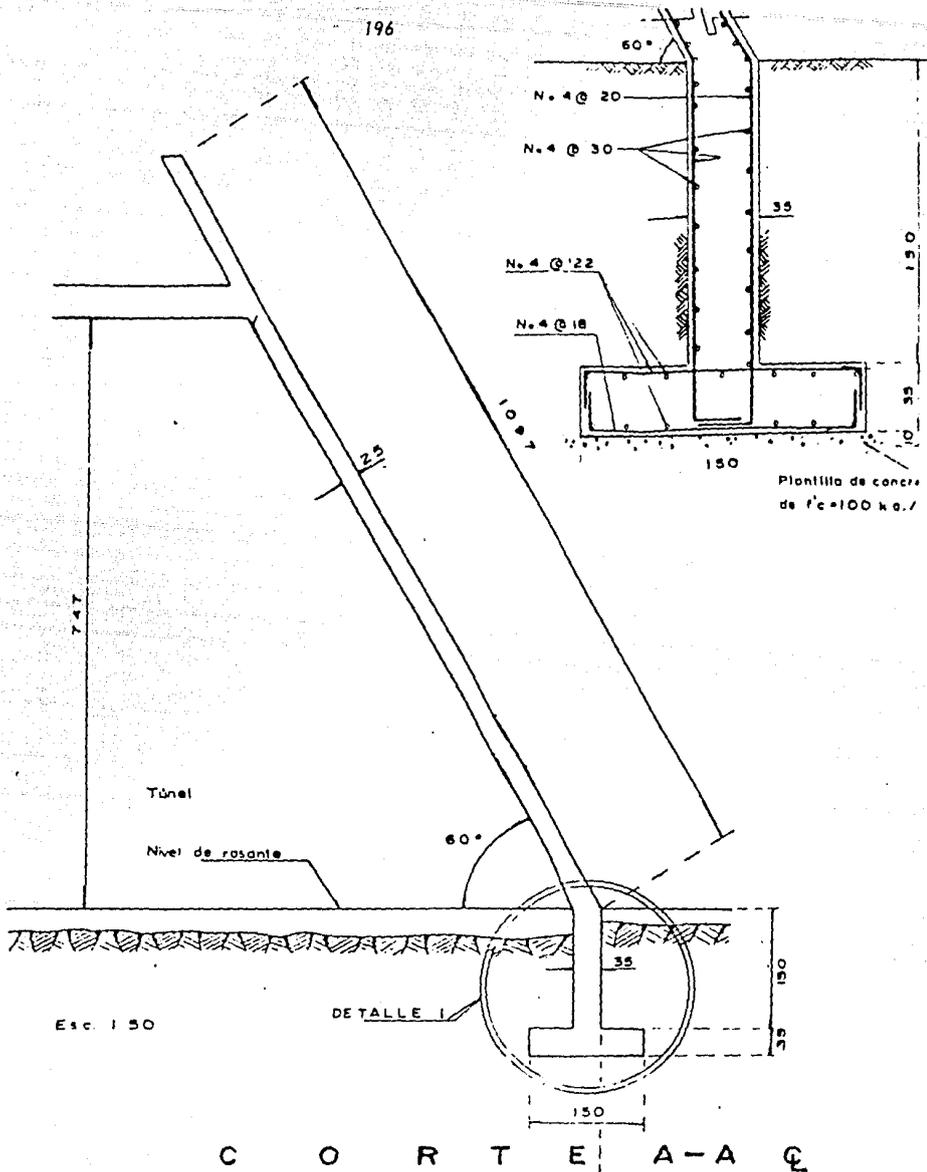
FIG. VB CORTE DE PLACAS DE EMPORALAMIENTO
